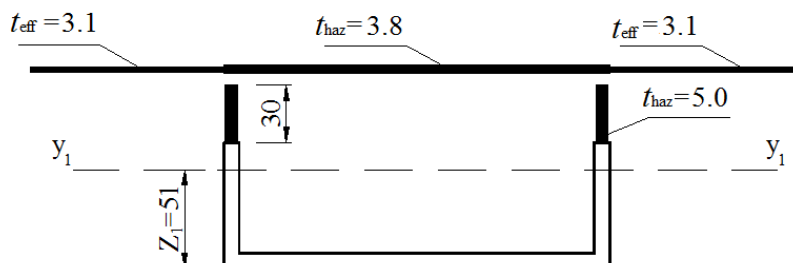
Sezione efficace per effetto dell'instabilità locale e delle HAZ.
